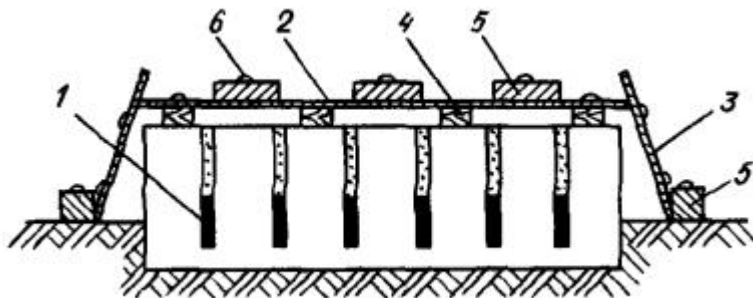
Установка сплошного щитового укрытия на фундаменте:
